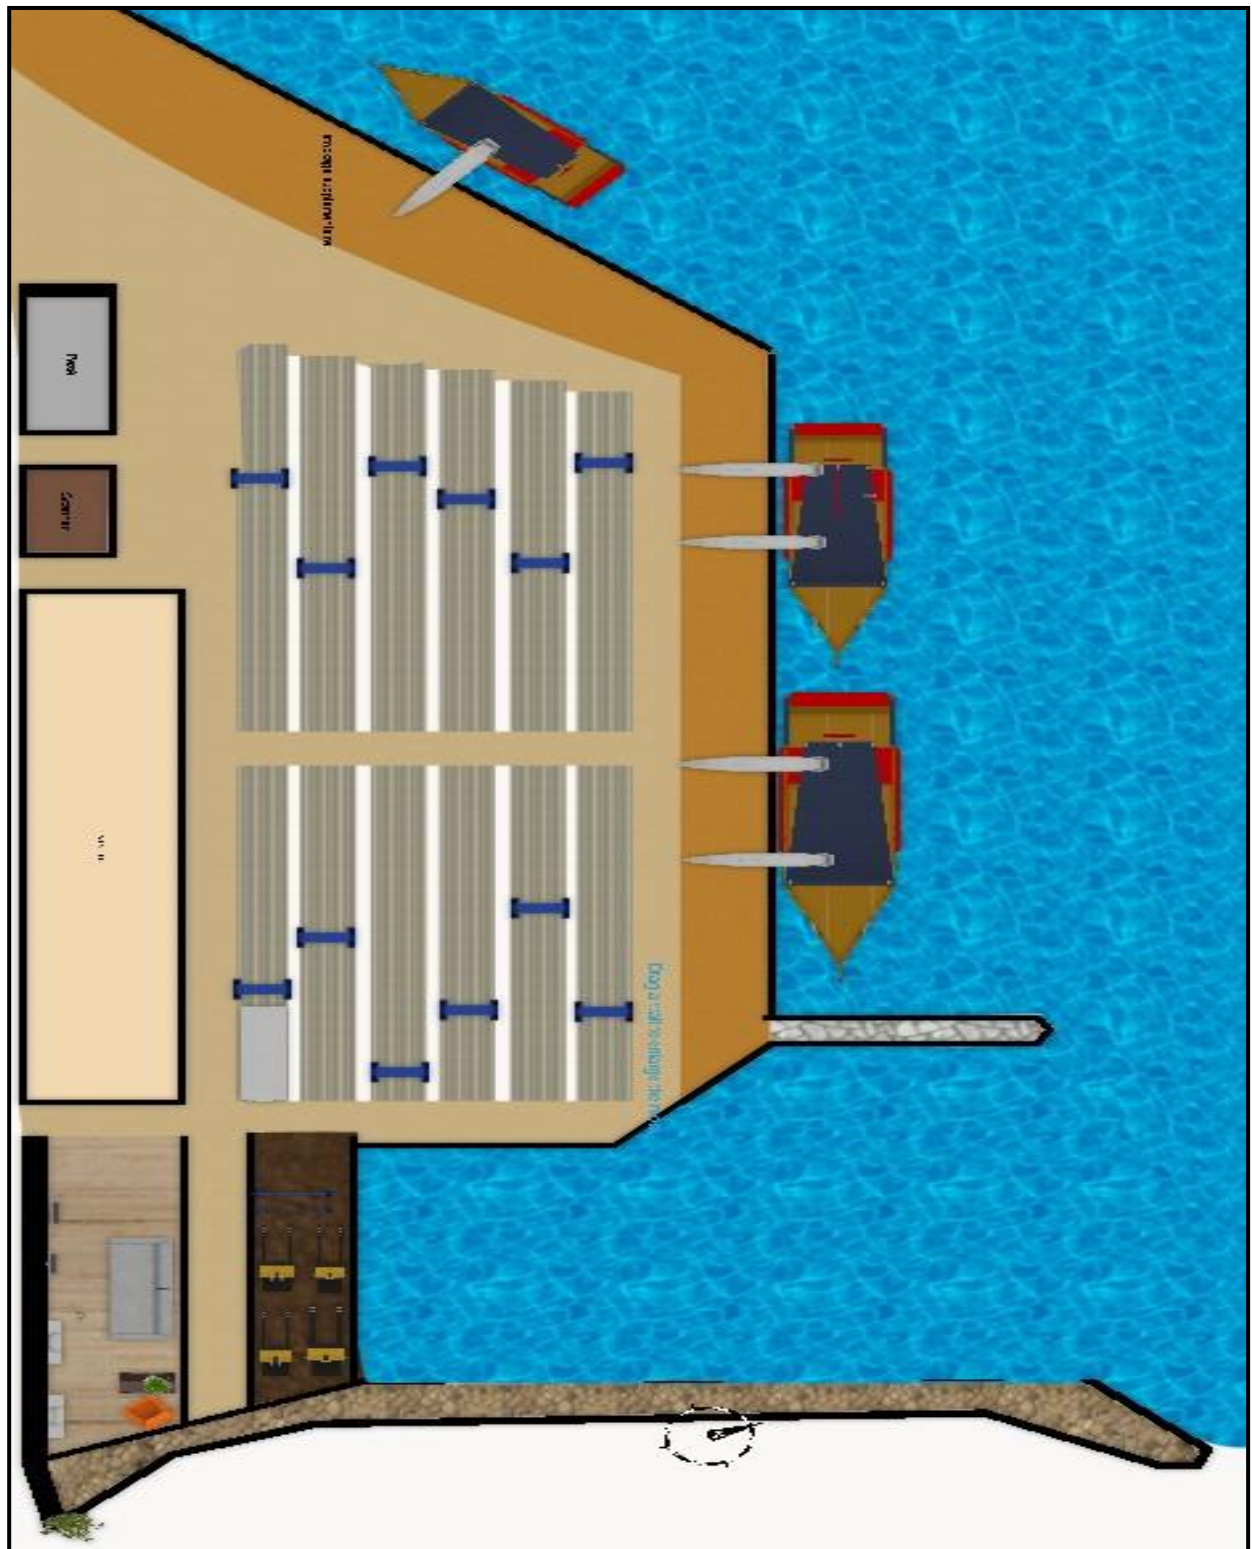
Modélisation du terminal 3D par PLANFLOOR
